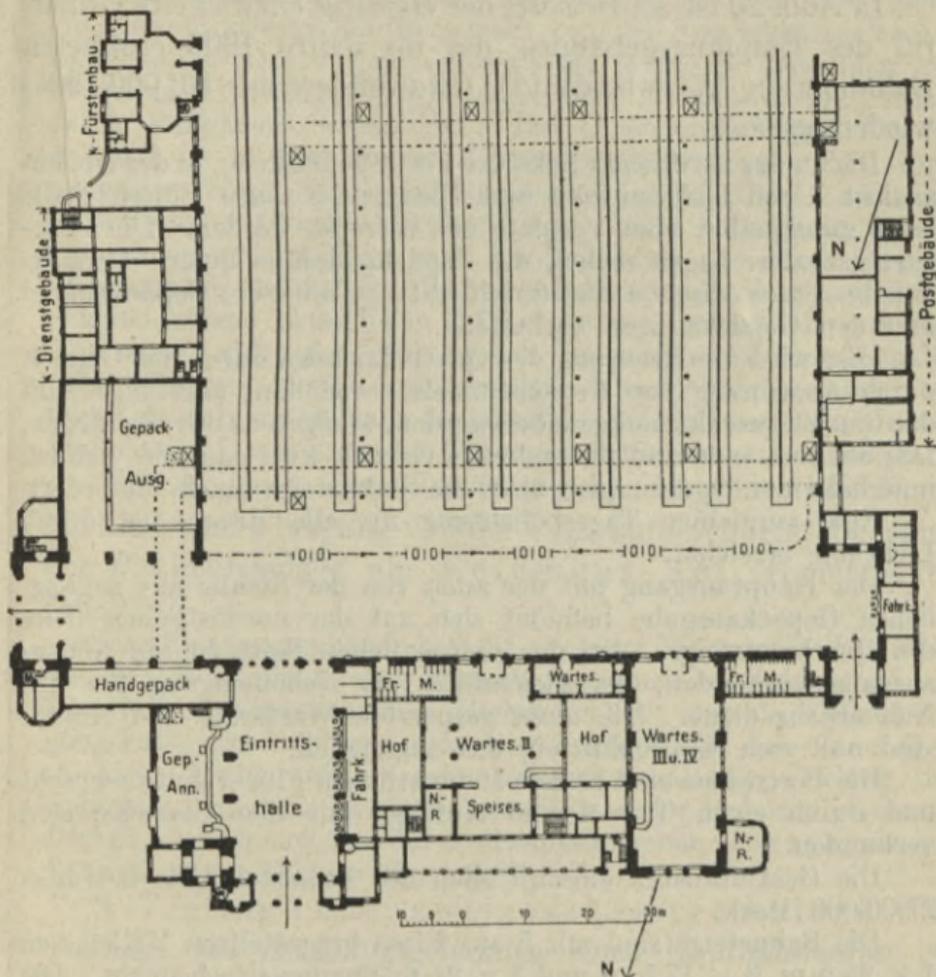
Grundriß des Empfangsgebäudes Wiesbaden. M. rd. 1 : 1800.
